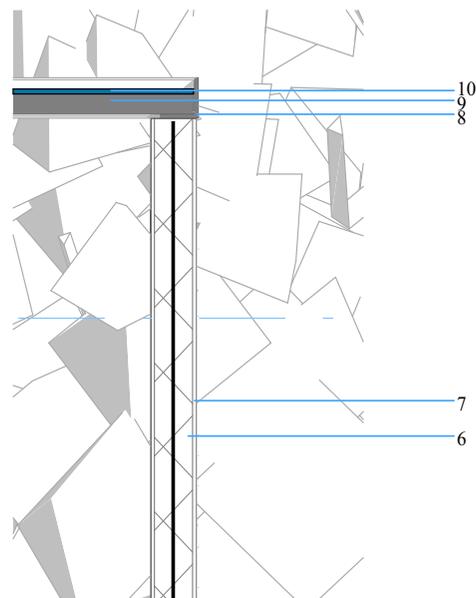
Detalle constructivo sección 6. Fuente: Autora.
